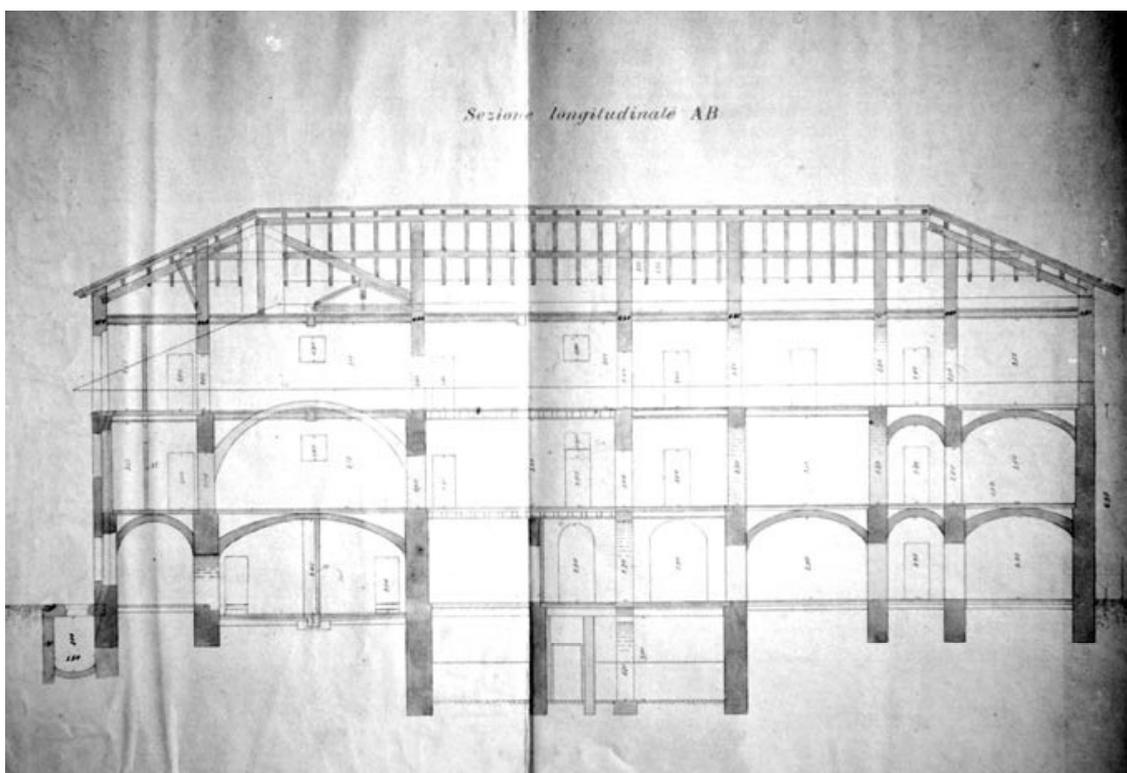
Progetto di ristrutturazione risalente a circa un secolo fa
